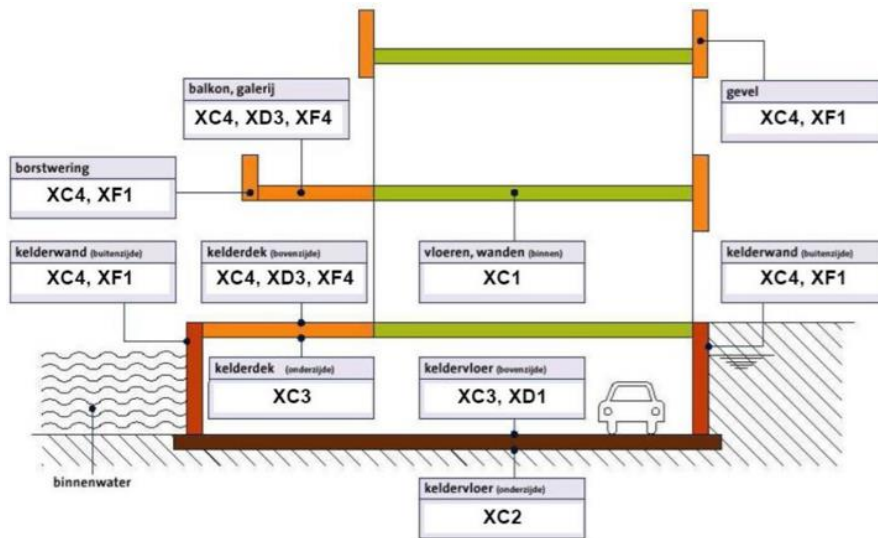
Betonsterkte klassen op hoogte-indeling
